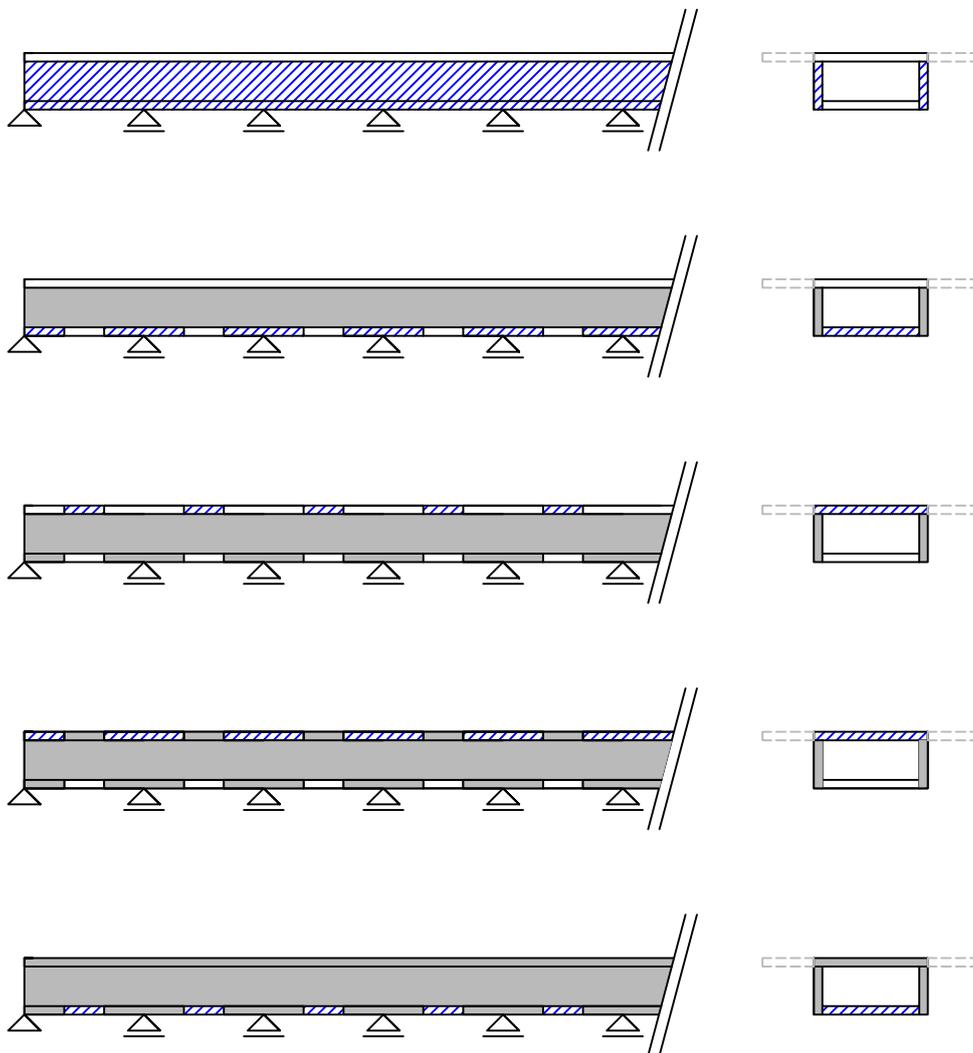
Ablauf des Herstellungsvorganges des fertigen Tragwerkes nach dem Einschub - Betonagevariante C (Eigene Darstellung in Anlehnung an Raphaela Hackl [1])
